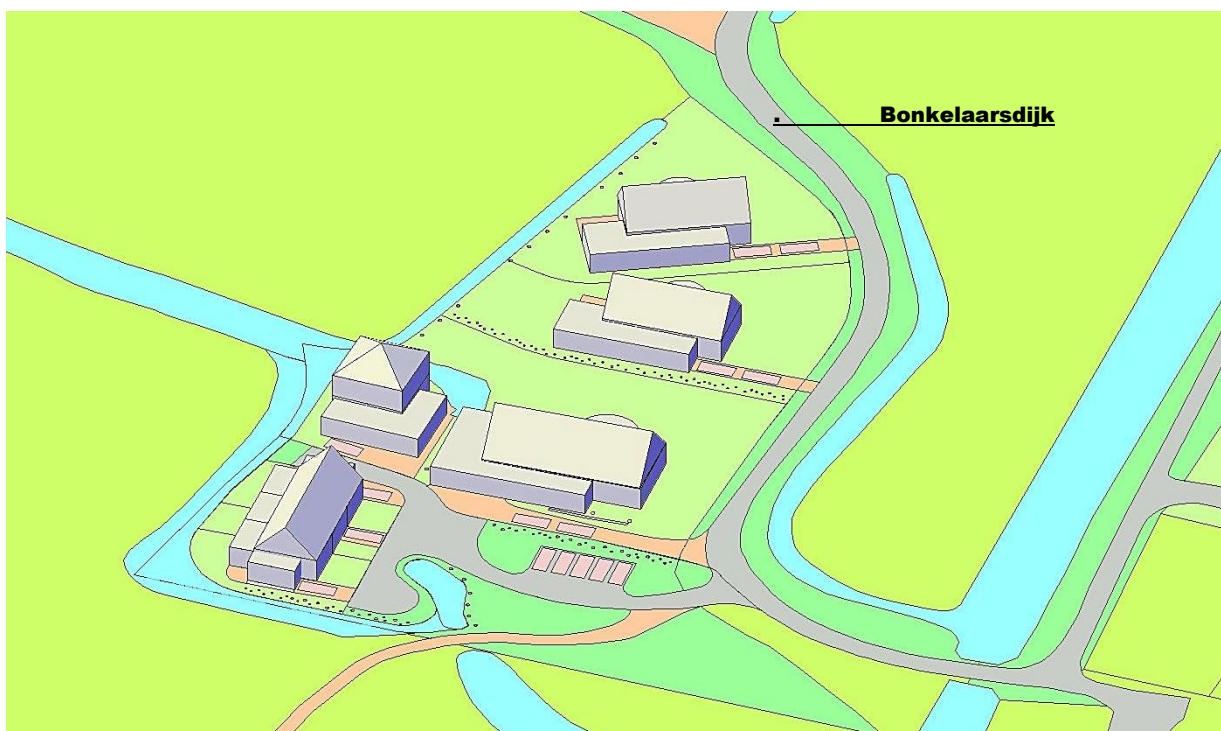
vogelvlucht vanuit het zuidwesten: impressie hoofd en bijgebouwen
